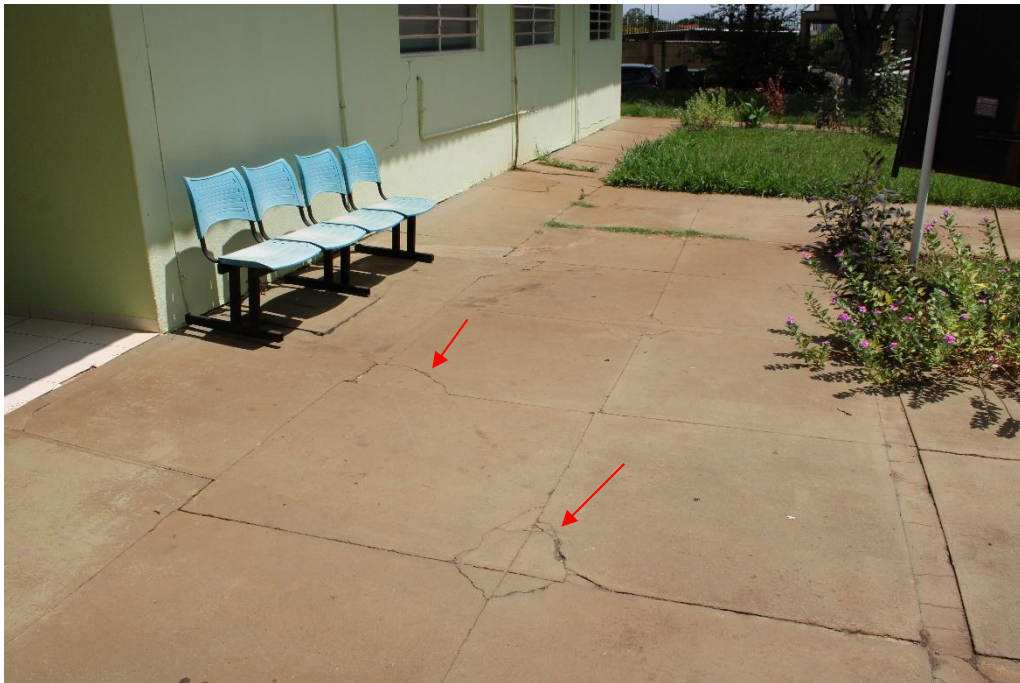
Fissuras em calçamento externo em concreto desempenado.
